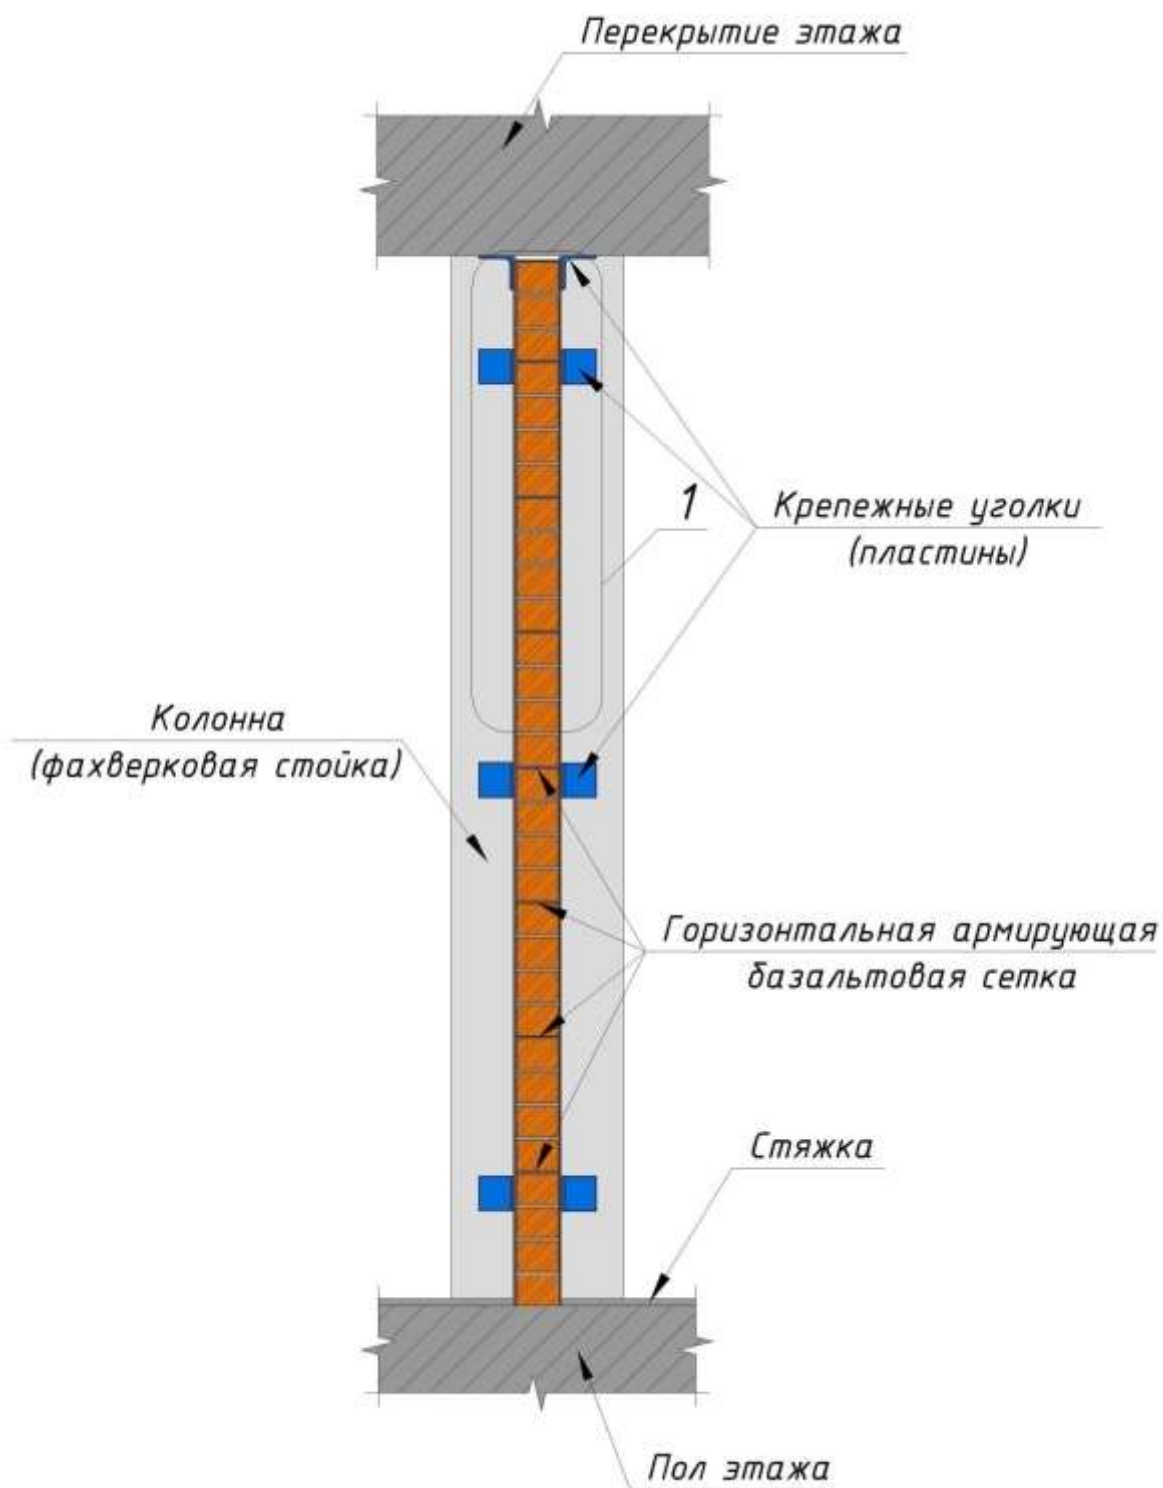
Схема крепления перегородки из различных стеновых материалов, усиленной композитной сеткой, к каркасу здания при толщине перегородки до 25 см
